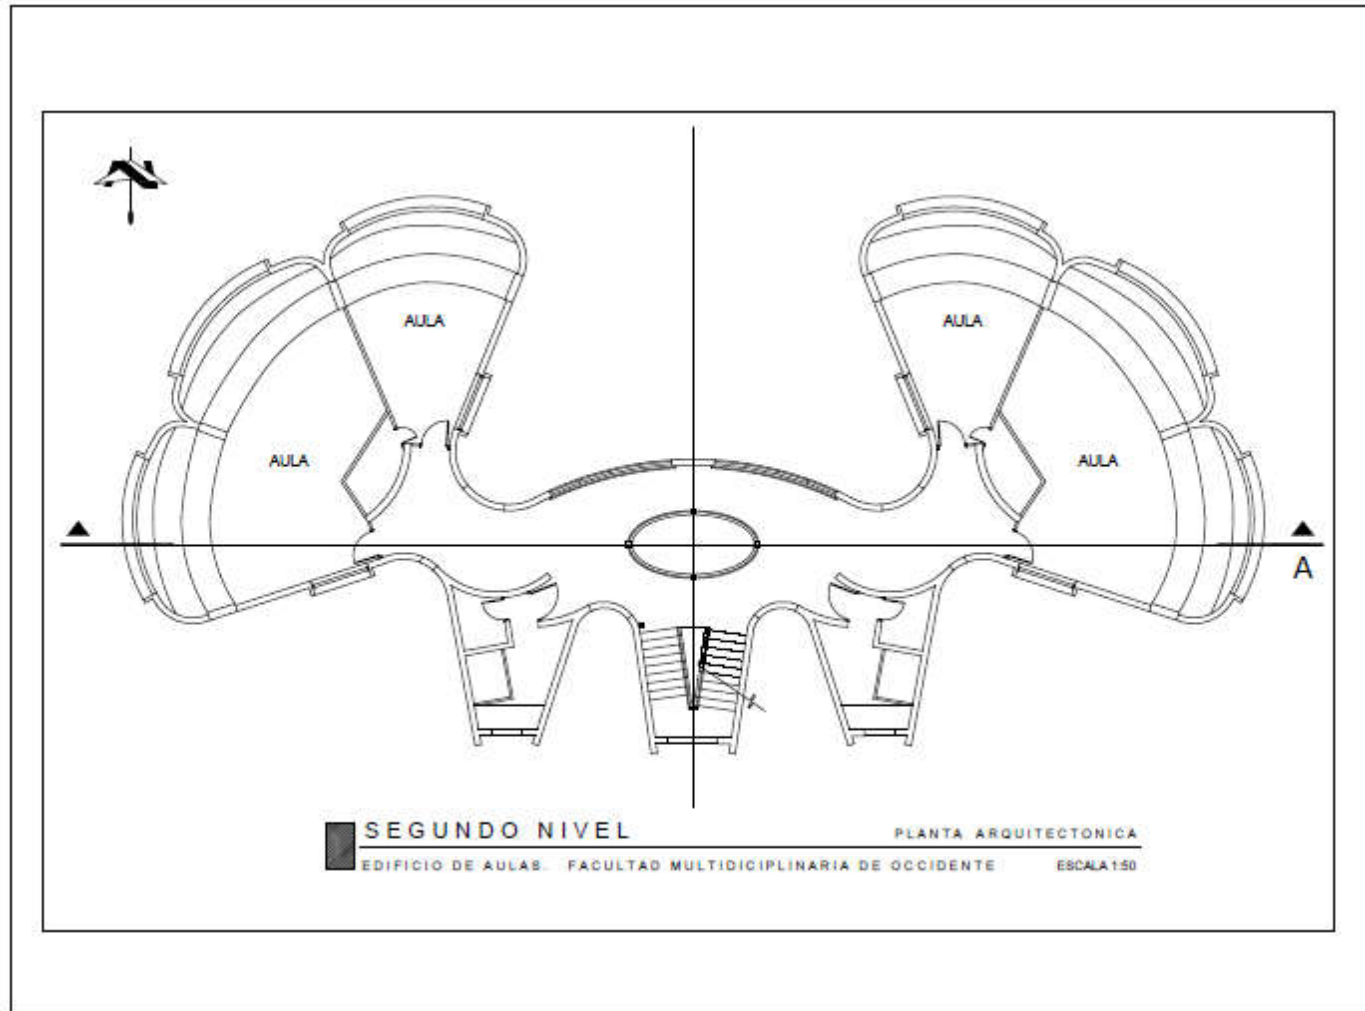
Planta arquitectónica del segundo nivel del Edificio Bunker
